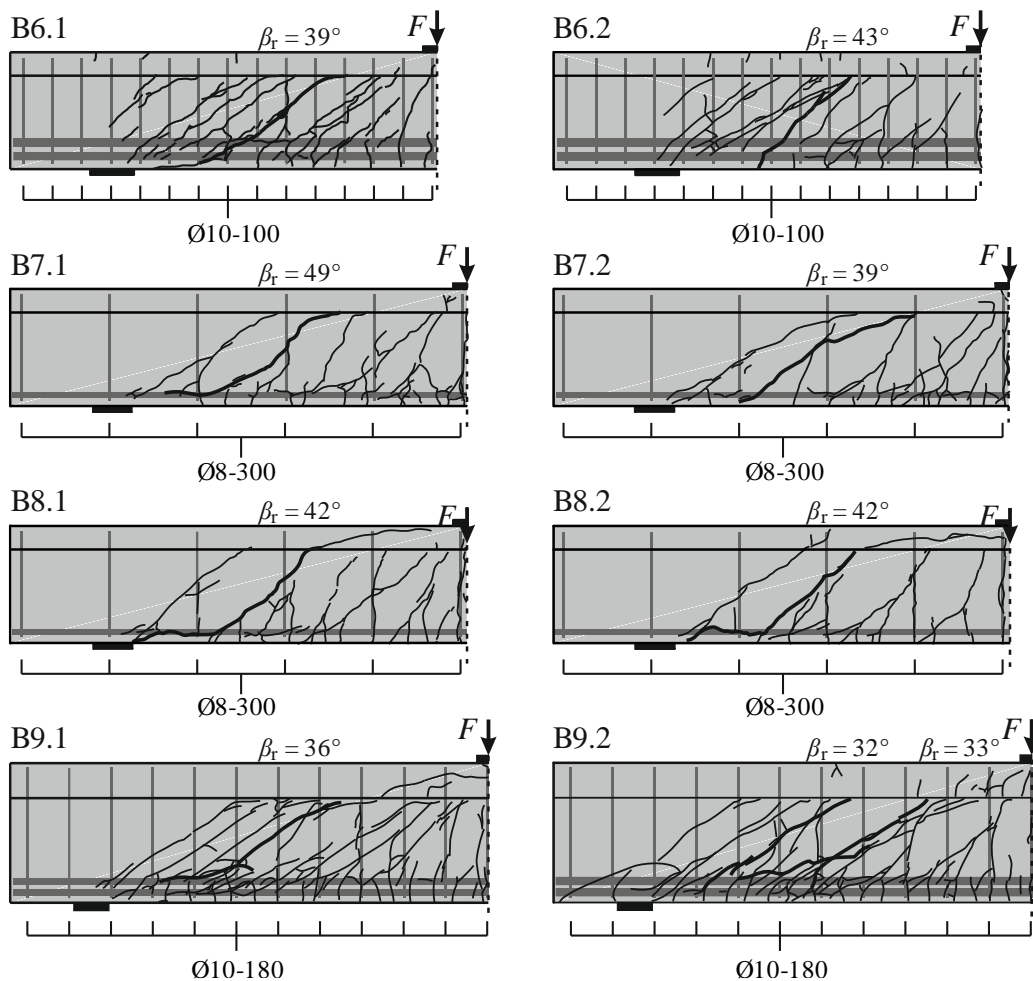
Rissbilder der Balken B6 – B9 [63]
